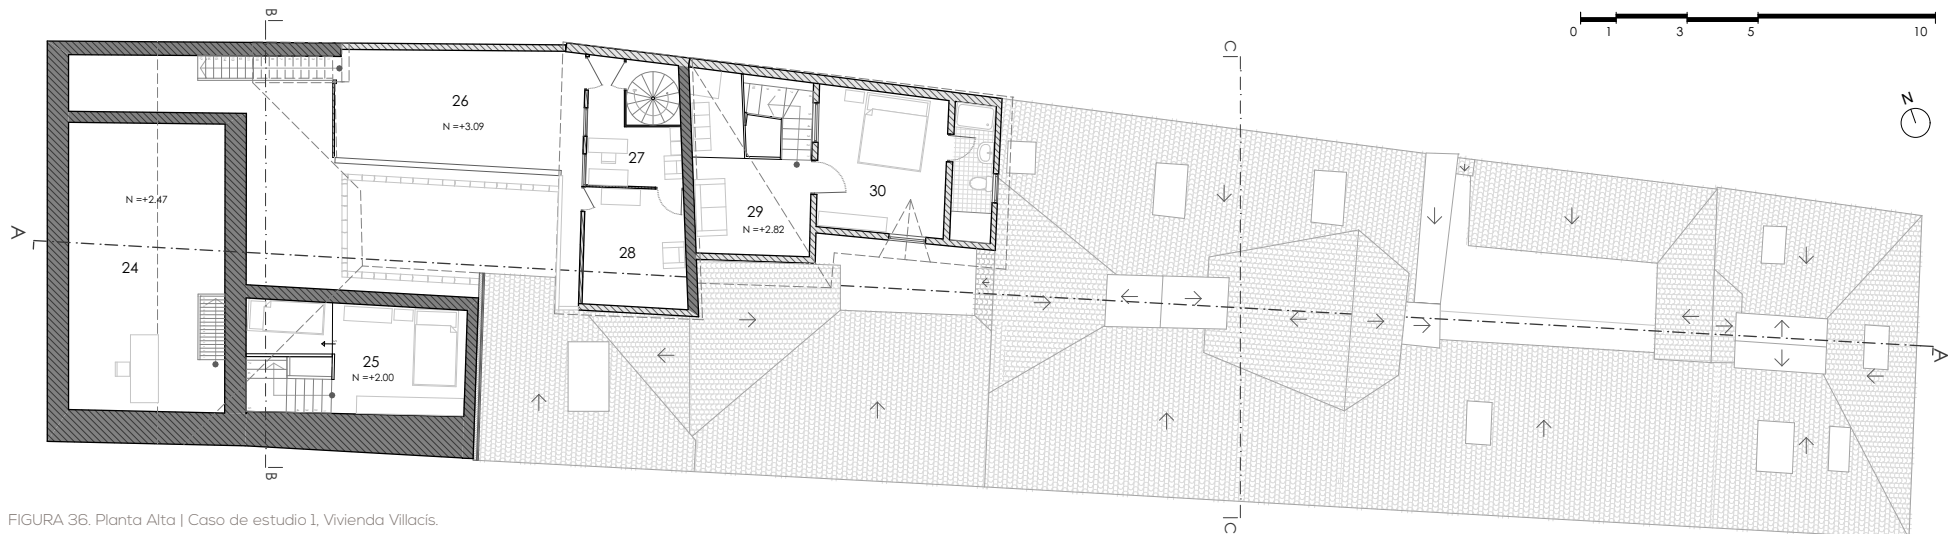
Planta Alta | Caso de estudio 1, Vivienda Villacís.
